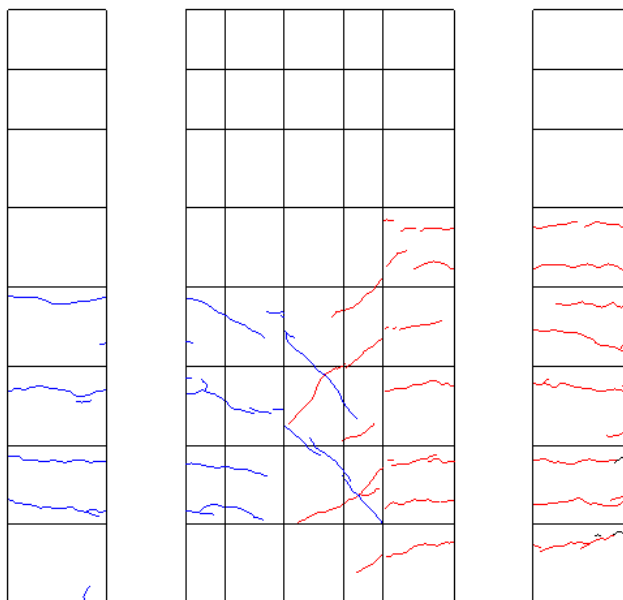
R=1/400②ひび割れ図
